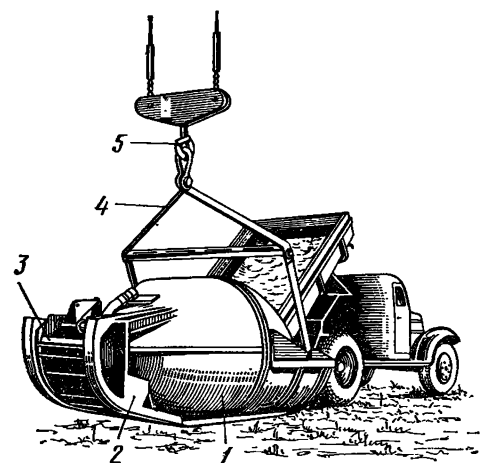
Выгрузка бетонной смеси в поворотную бадью вместимостью 3,2 м³:
